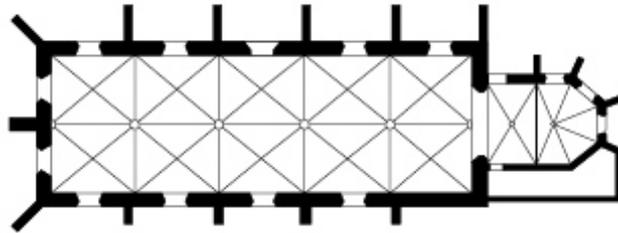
Grundriss der ehemaligen Klarissenkirche in Dürnstein, gegründet vor 1289
